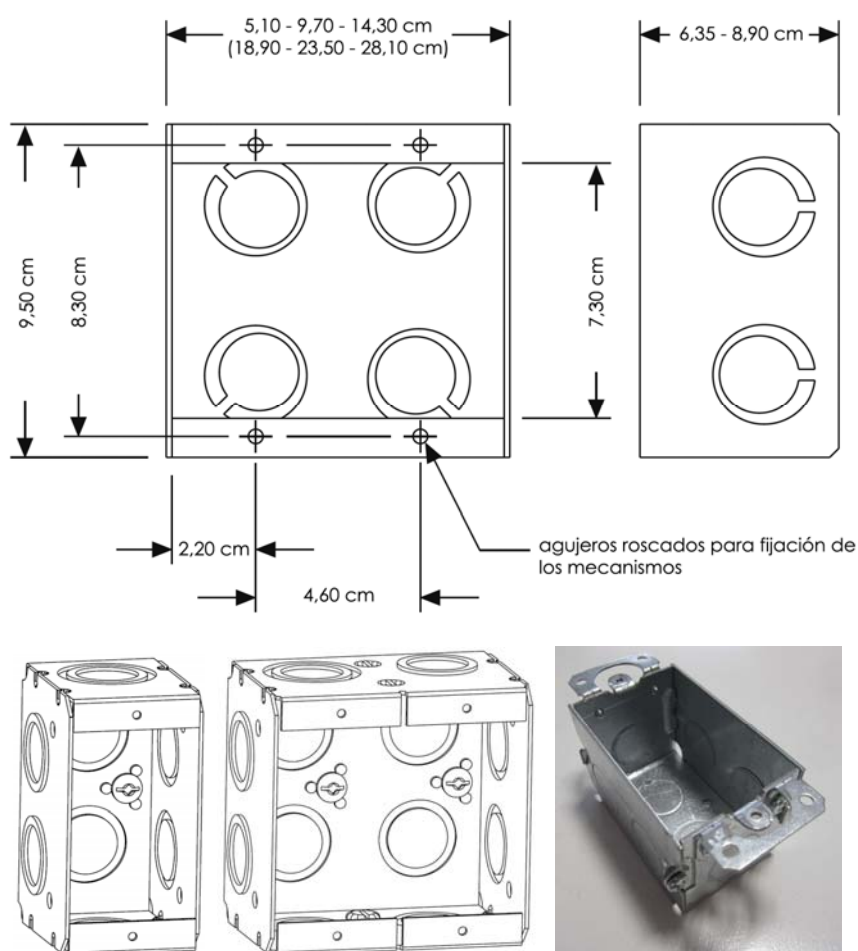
Caja de empotrar universal metálica. (Mercado americano).
